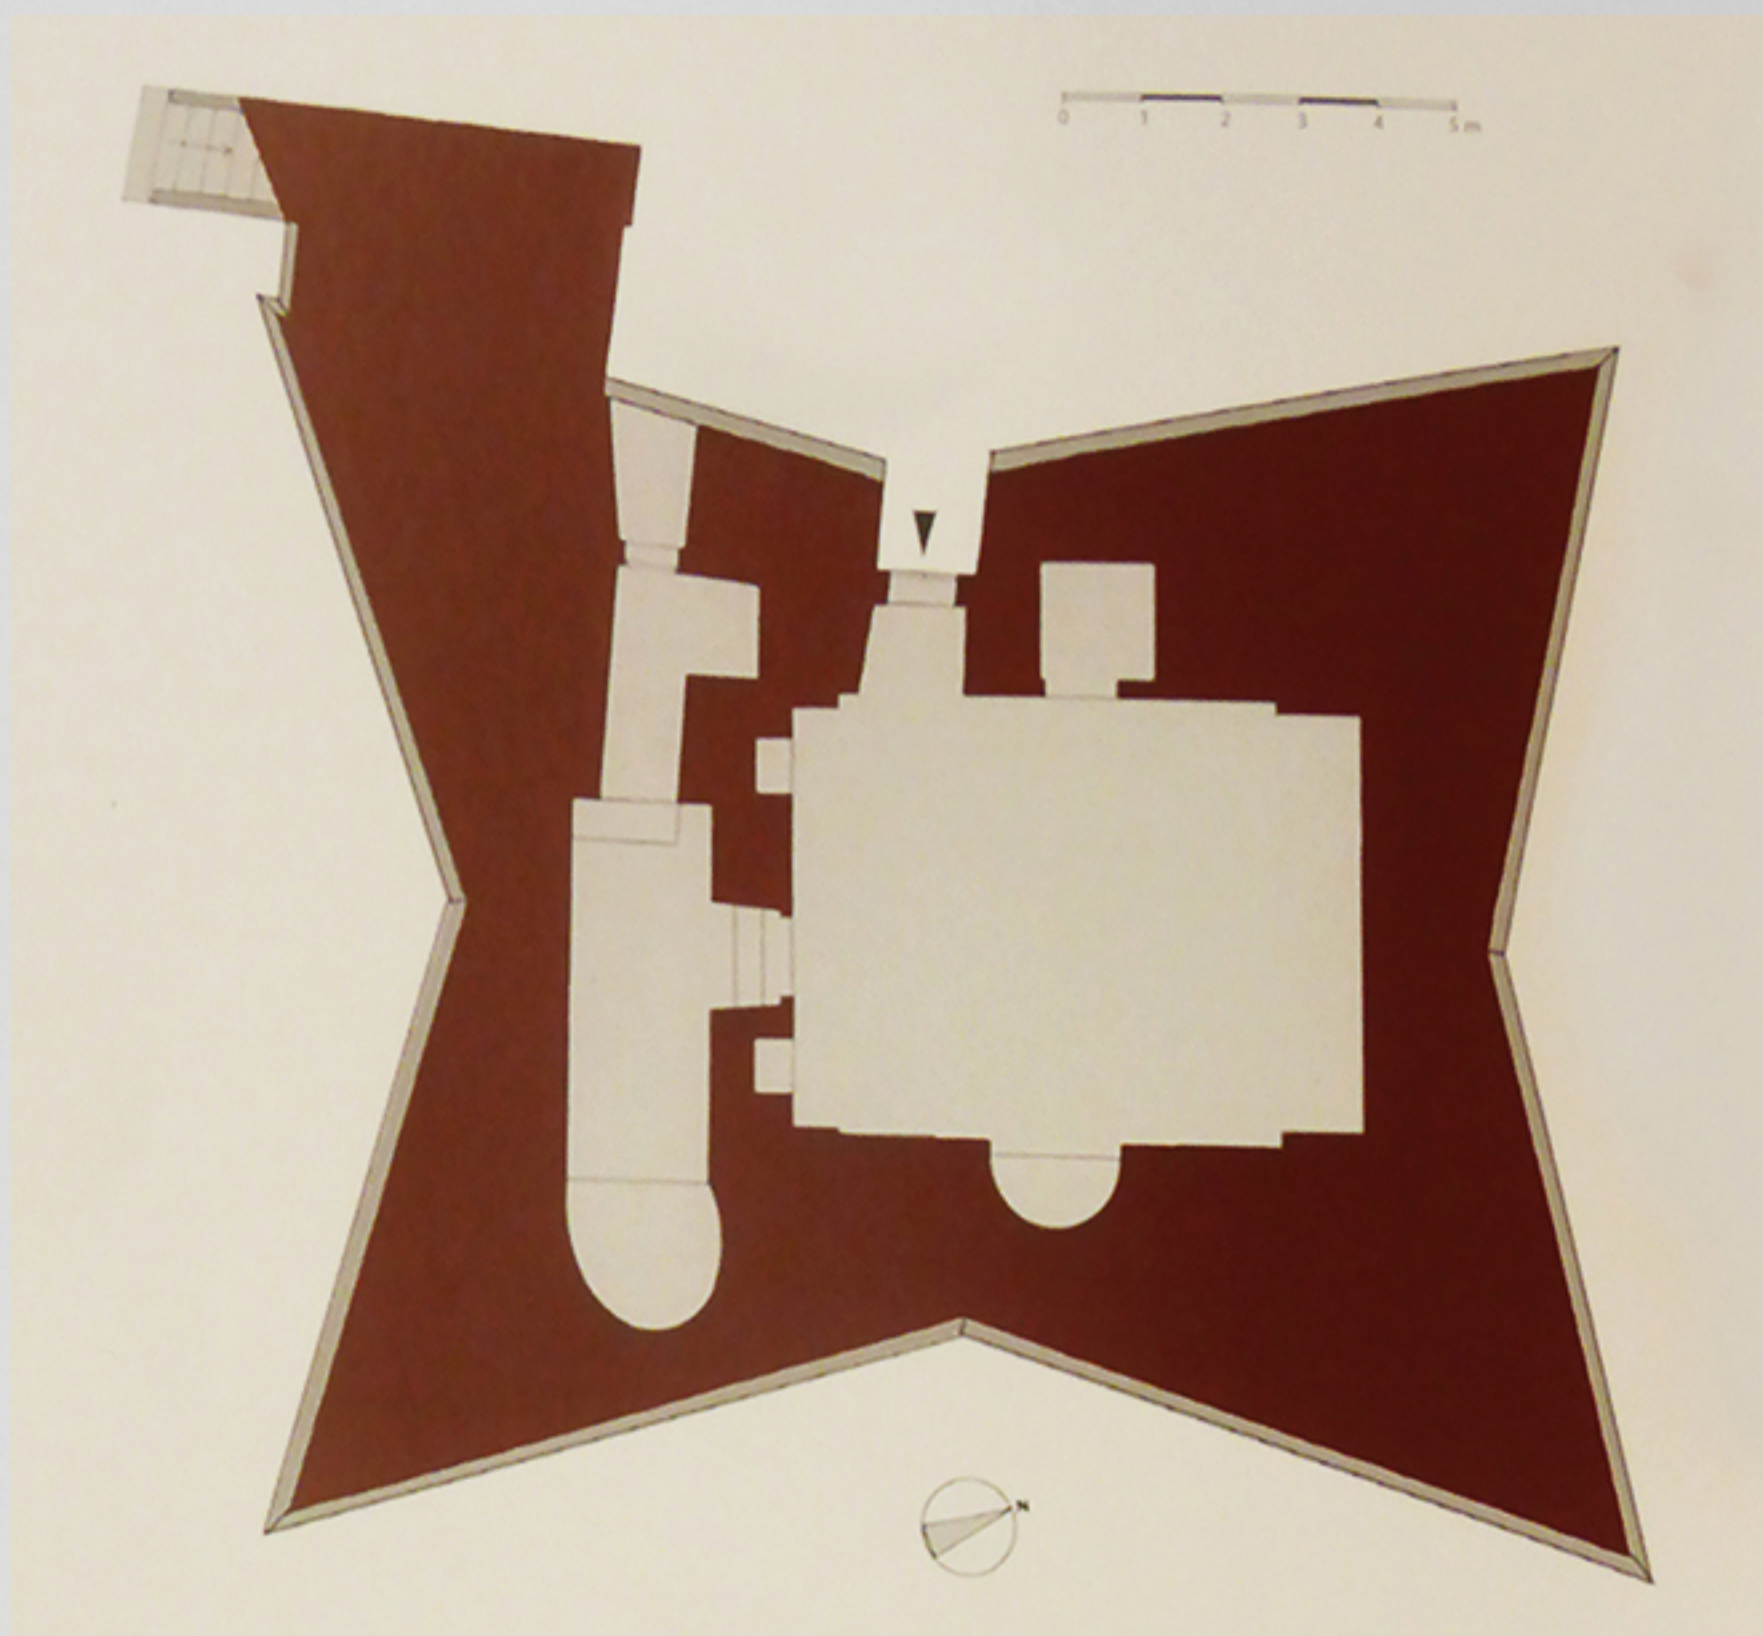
Torre di S. Pietro in Bevagna. Ipotesi della pianta del complesso nel XIX secolo (quota + m. 4,50).
